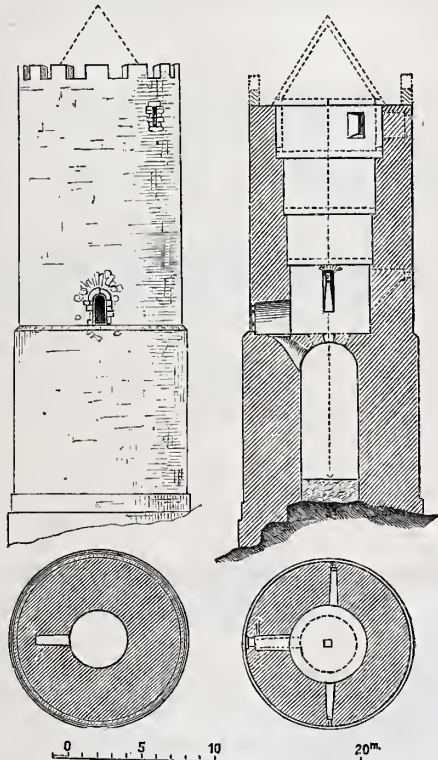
Südliche Ansicht und Grundriss des Verließes. Abb. 6. Durchschnitt und Grundriss des Hauptgemaches.
